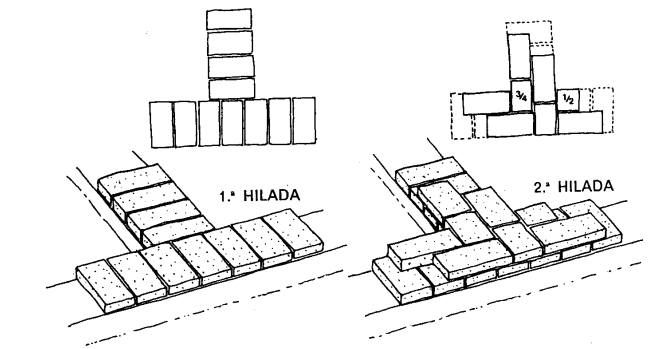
Encuentro de muro en "T" con ladrillos opuestos.
